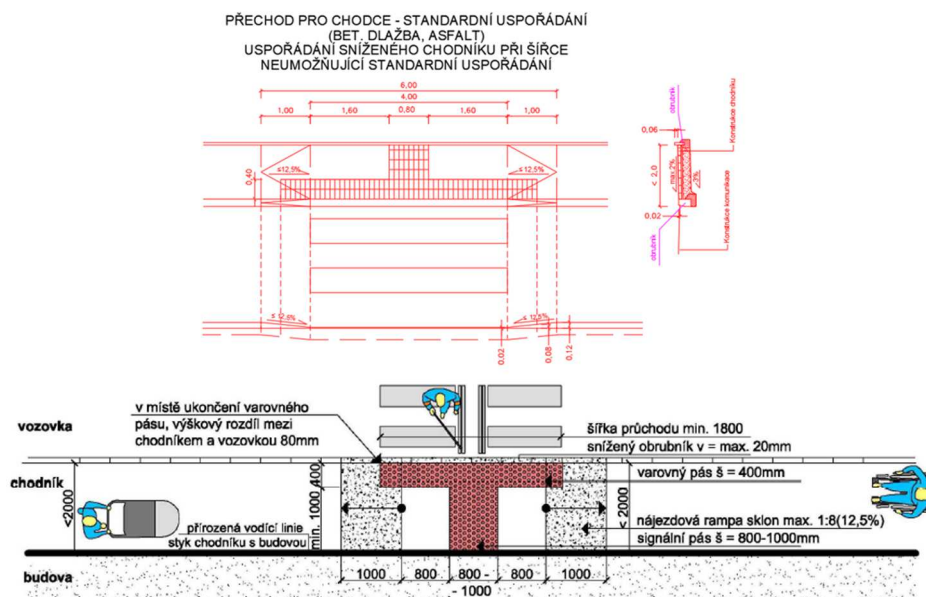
Přechod pro chodce – vzorové uspořádání včetně standardní hmatové úpravy v místě přechodu [6]
